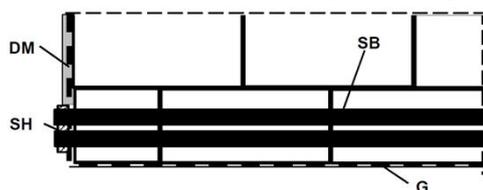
für Plan- und Planfüllziegel nach Anlagen 7 und 8
